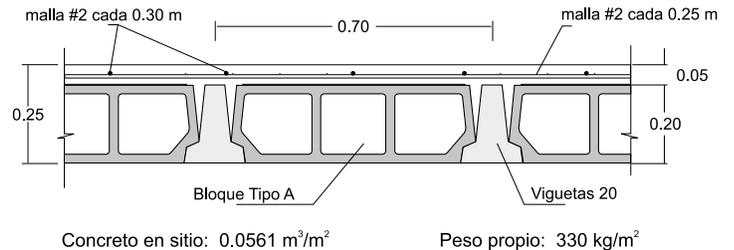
Detalle típico de entrepiso de vigueta de 20 cm con bloque tipo A
